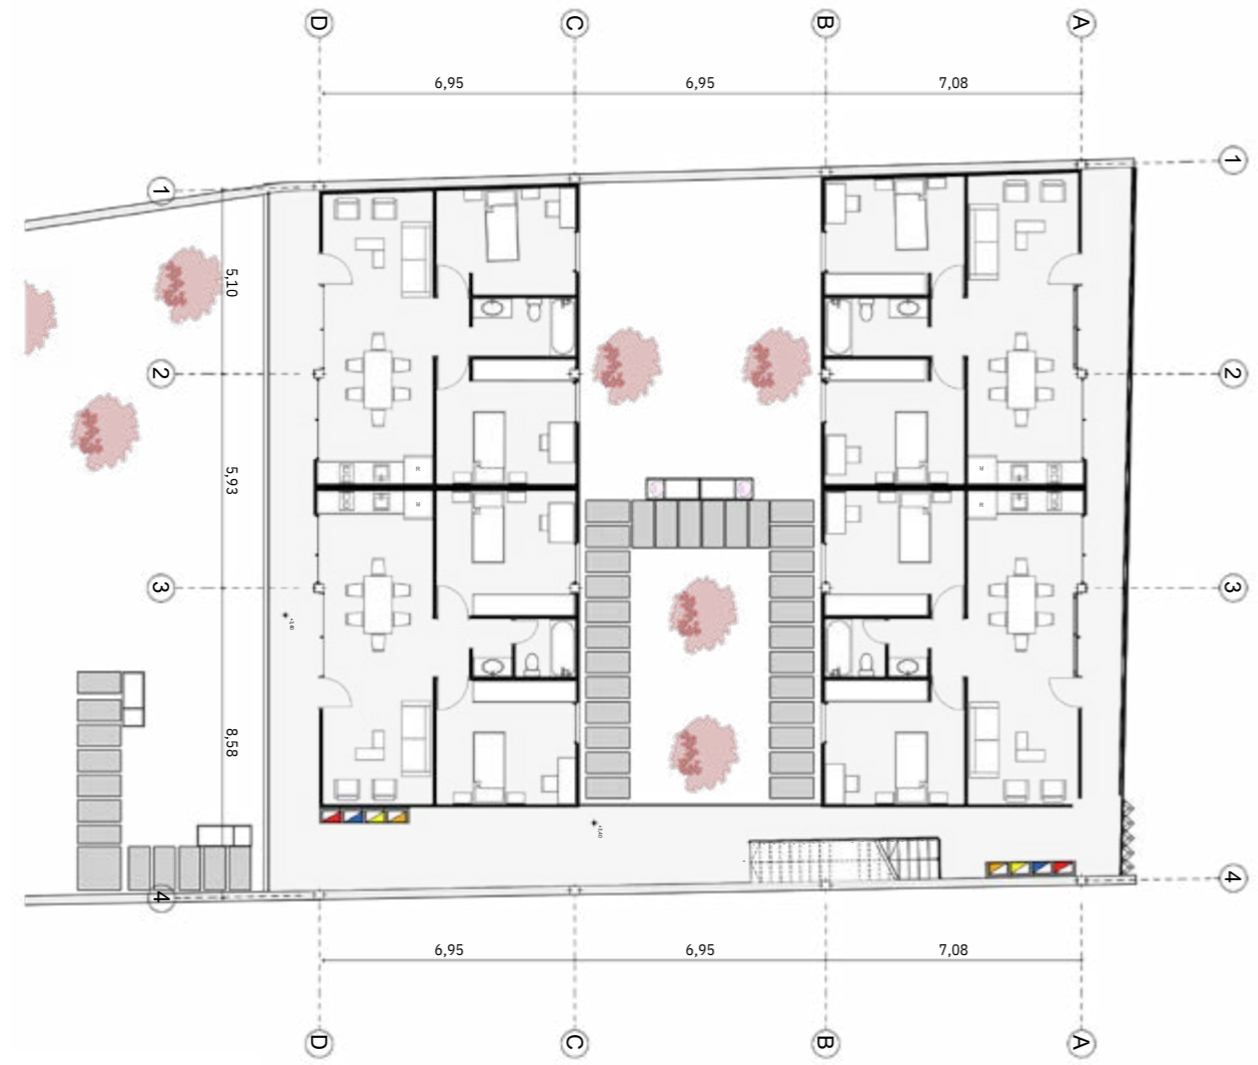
Planta alta 1 y 2 del proyecto - Bloque 3. Nota. Elaboración propia
